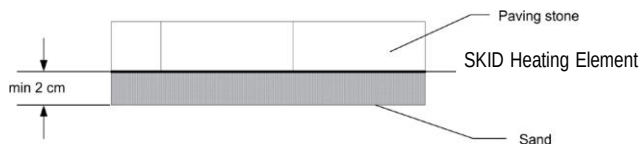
Stratigrafia sotto pavimentazione in pietra
